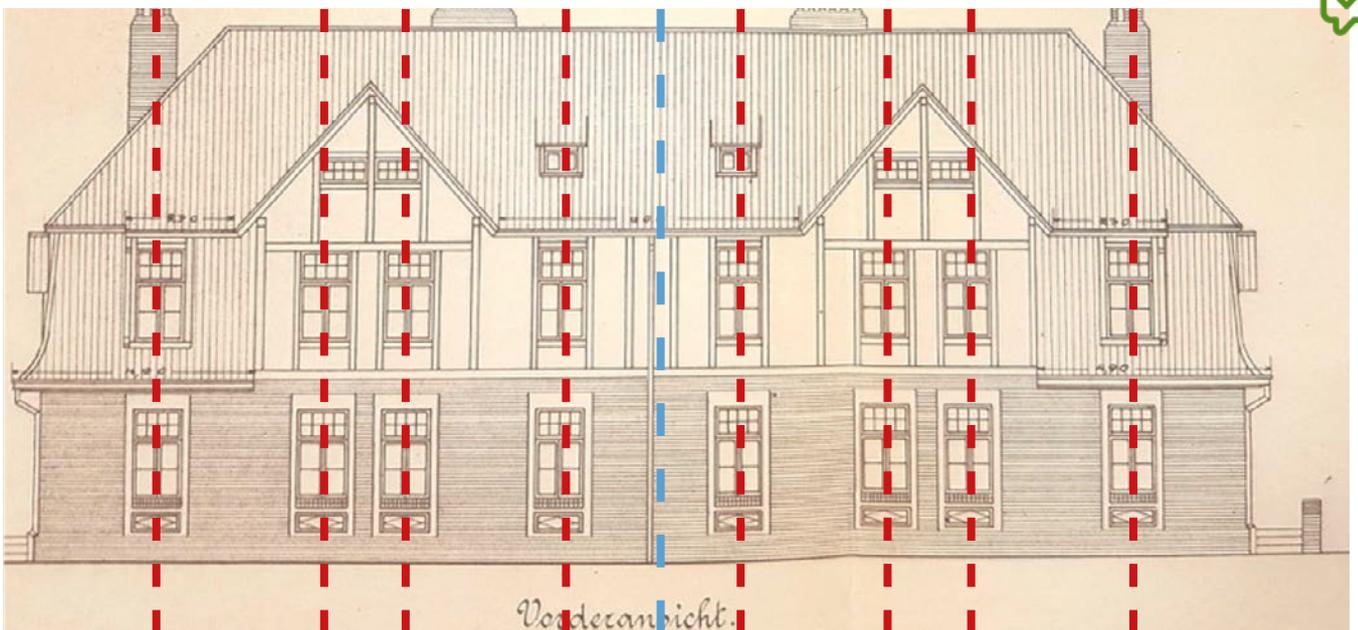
Fassadenöffnungen mit Bezug zu den vertikalen Achsen
